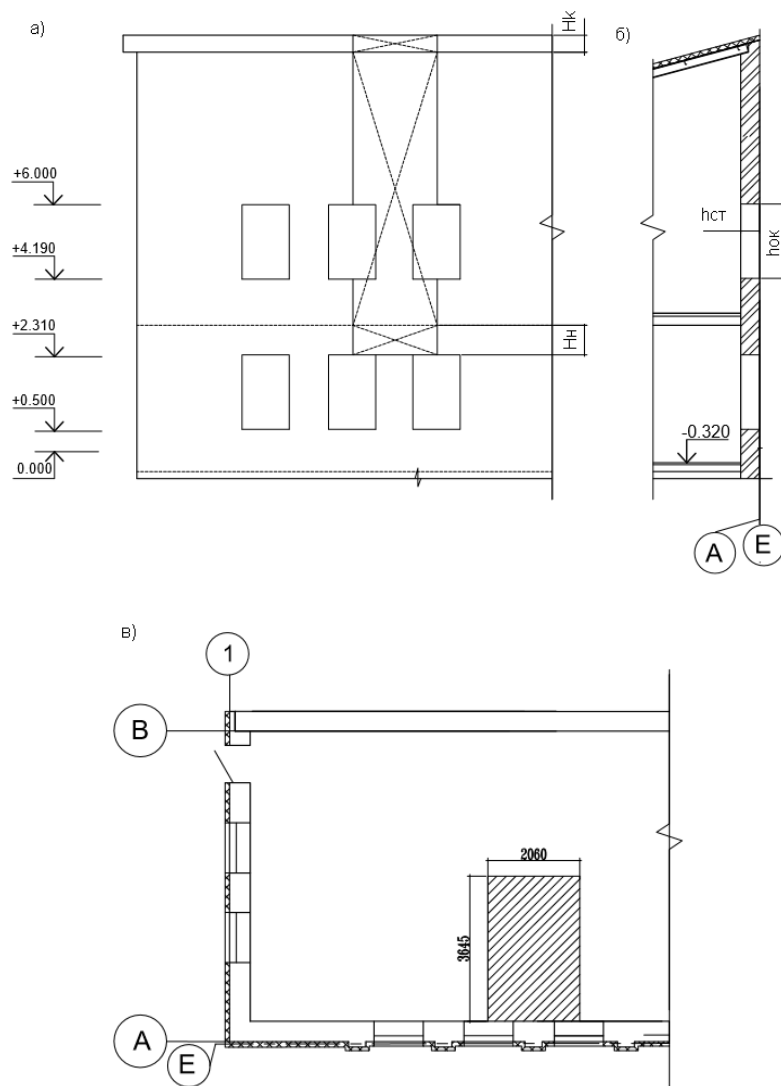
Схема к сбору нагрузок на простенок: а – фасад; б - разрез по продольной стене; в – план
